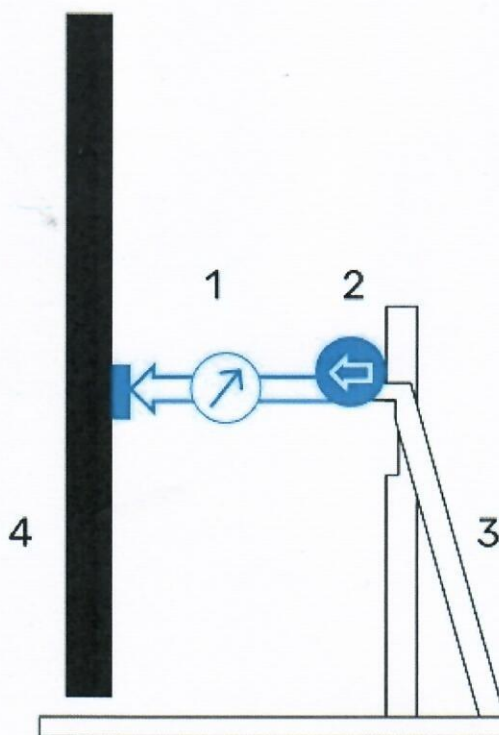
Схема испытательного стенда для приложения горизонтальной нагрузки
